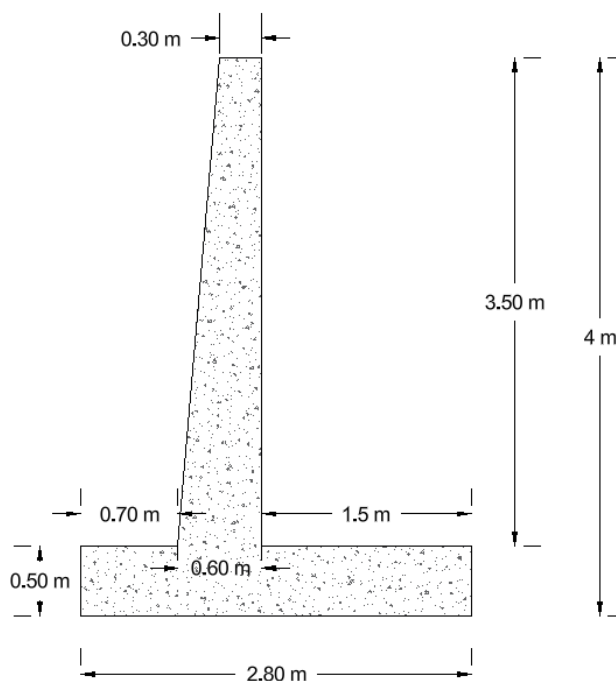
Dimensiones de muro de contención en voladizo de altura de 4 metros.
